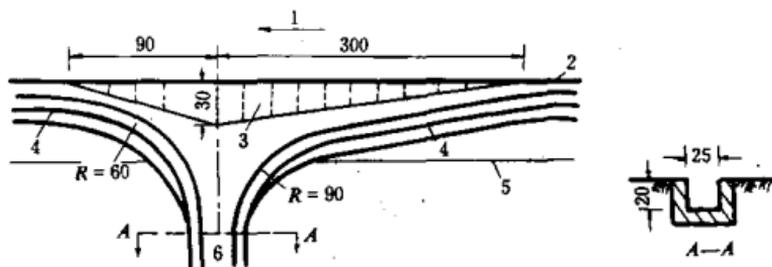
纵坡坡段上拦水带不对称泄水口的平面布置示意(尺寸单位:cm)
